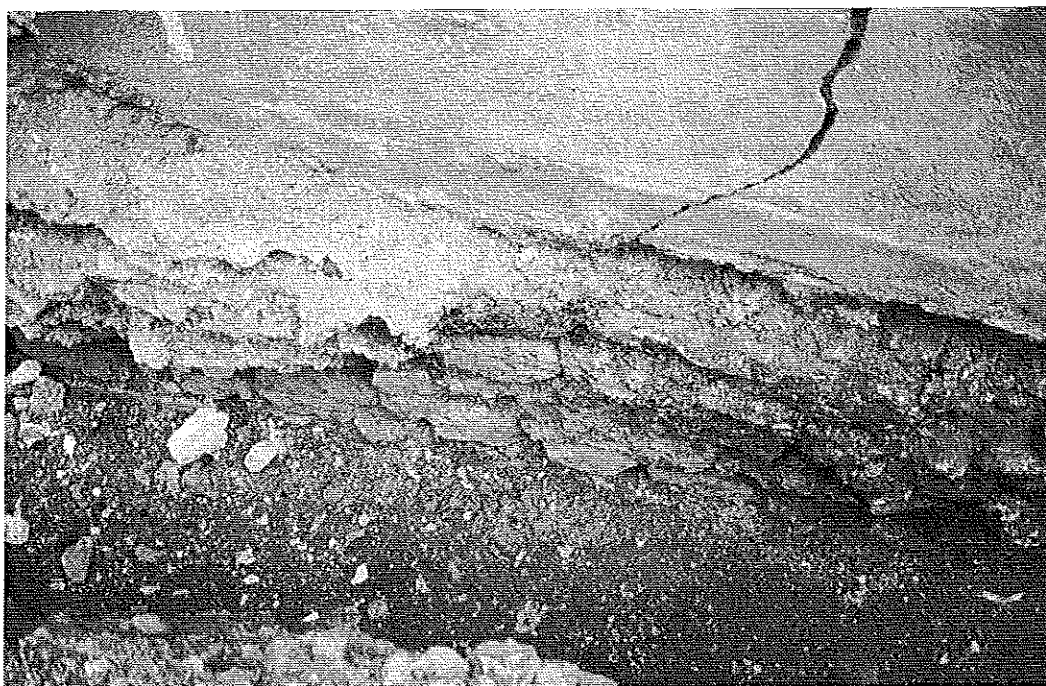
Détail base du mur au droit de la fondation inexistante. © J. Putatti
